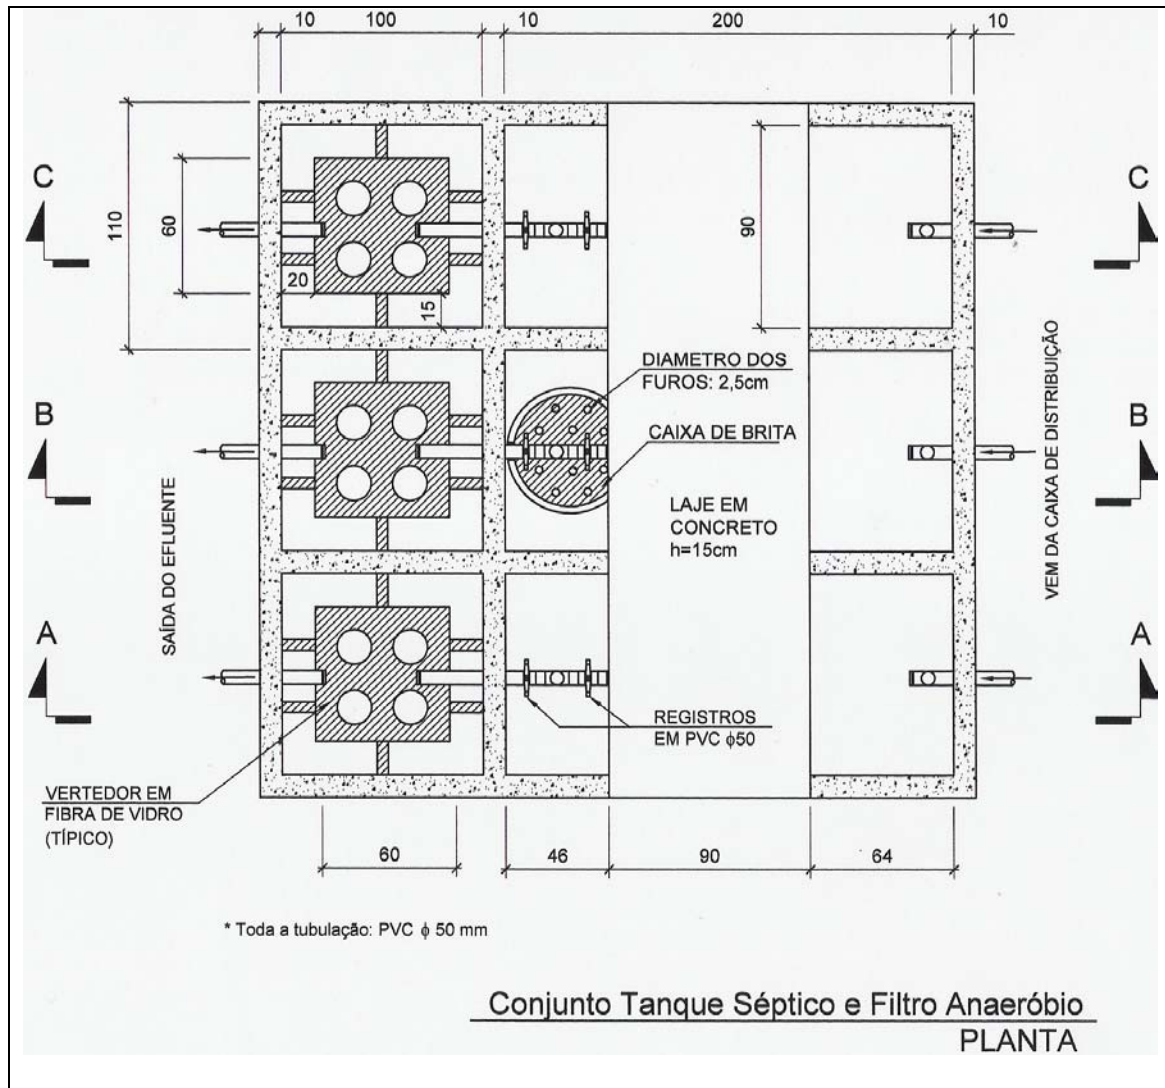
Conjunto Tanque Séptico e Filtro Anaeróbio - Planta
